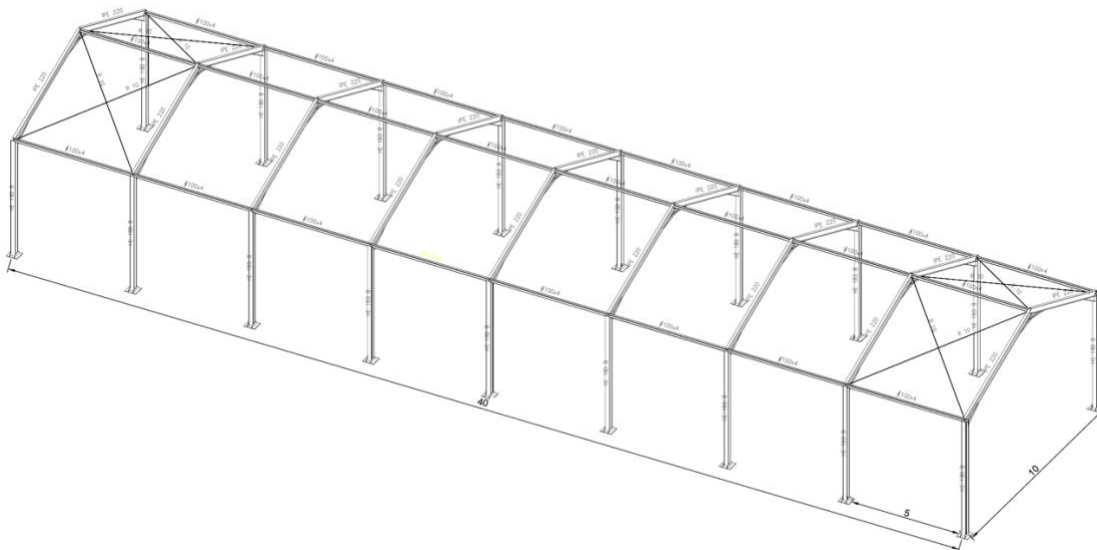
Geometría de la estructura. Fuente: CYPE 3D.
